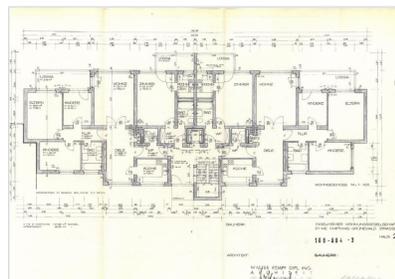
Grundrissplan eines OGs des Referenzgebäude (Hausverwaltung)
